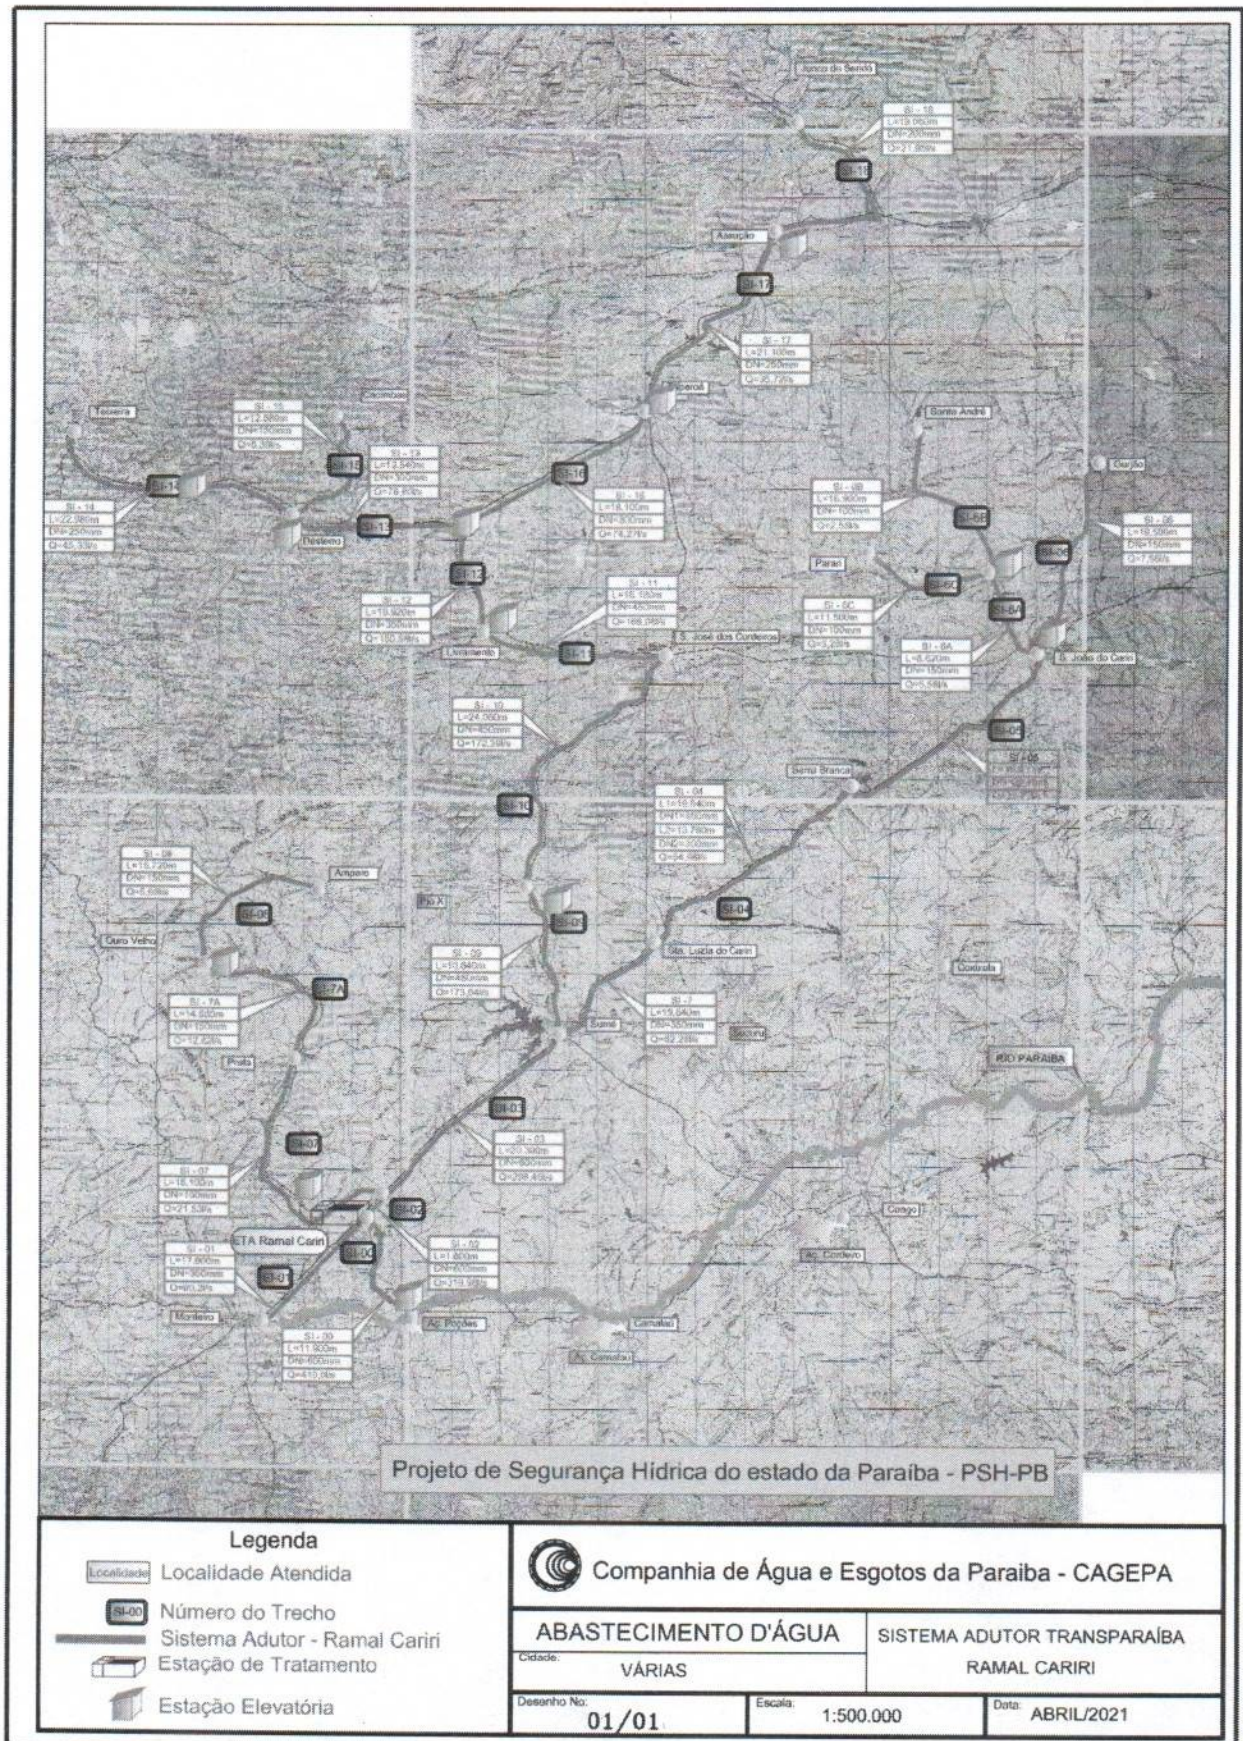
Layout Geral da Obra (Ramal Cariri)
